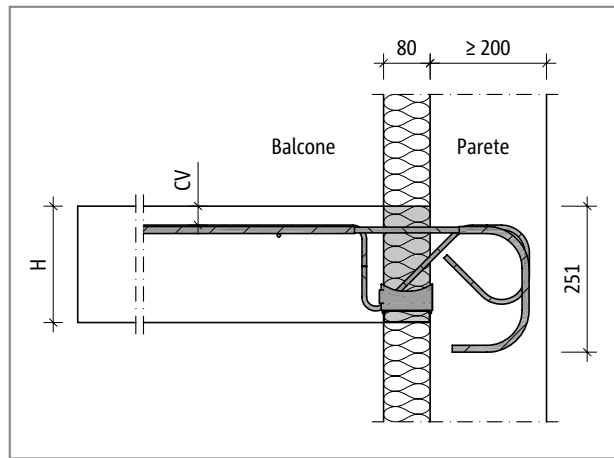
Schöck Isokorb® tipo K70M-UZ – K110M-UZ: raccordo alla parete con isolamento esterno
